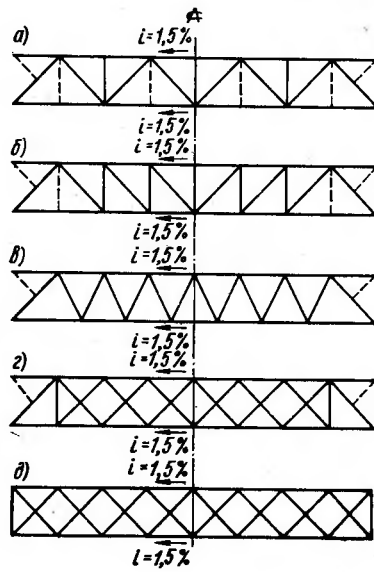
Схемы стропильных ферм а — с треугольной решеткой и с дополнительными стойками (типичная схема); б — с раскосной решеткой; в — с треугольной решеткой; г — с перекрестной решеткой со сжатыми опорными раскосами; д — с перекрестной решеткой
